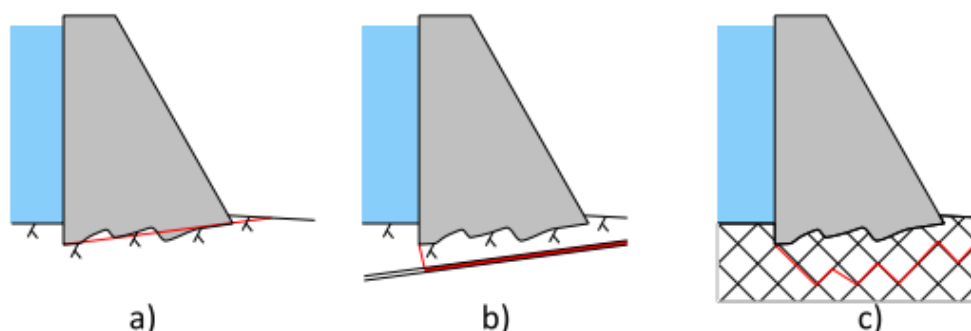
Princípio de deslizamento de uma barragem de concreto a gravidade
